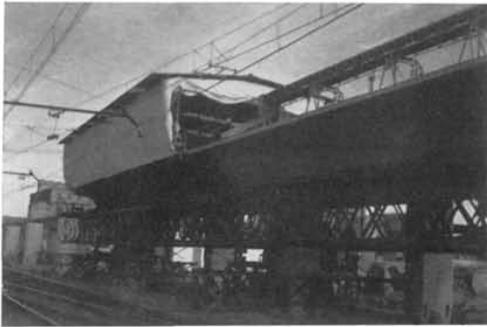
Vista de la cimbra en invierno, con las lonas de cierre. Puede verse la cinta transportadora para el hormigonado.
